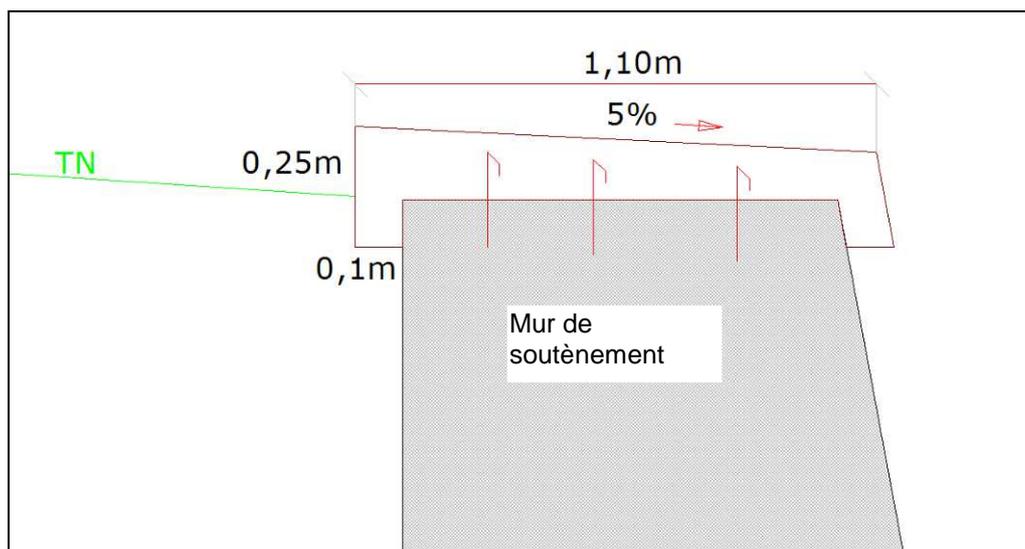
Coupe de principe sans échelle du chaperon de protection de la crête du mur de soutènement
